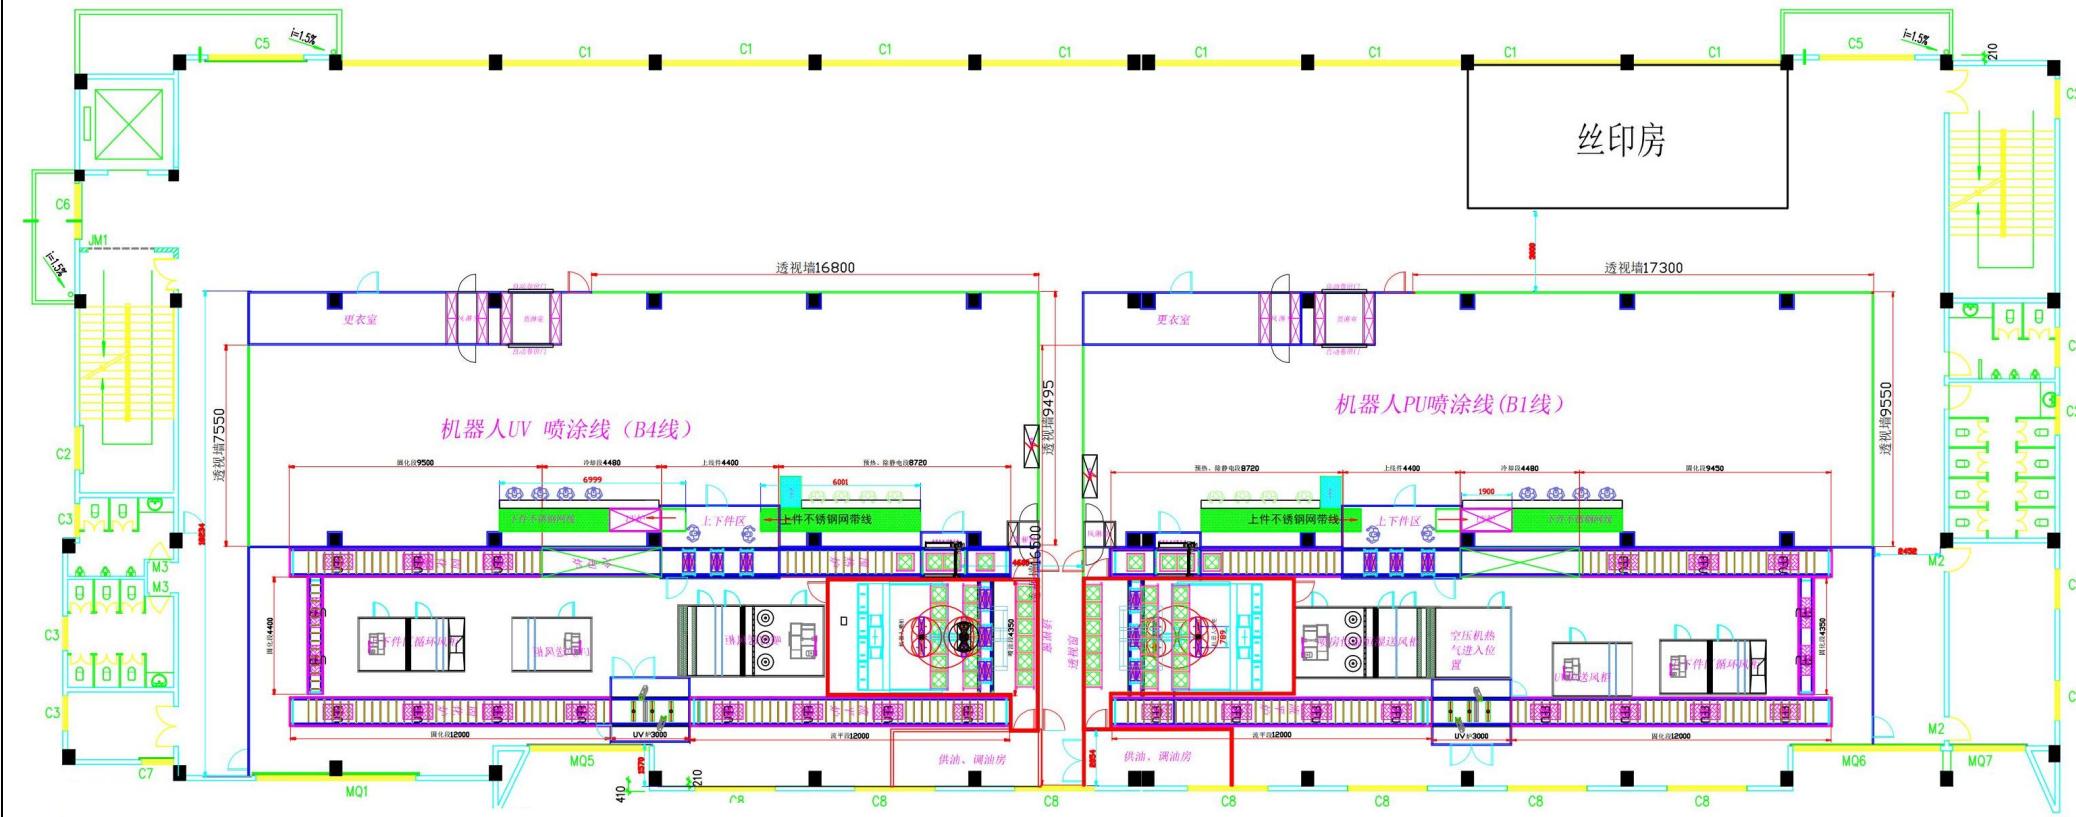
项目四楼 B1 及 B4 喷涂线平面布置图
